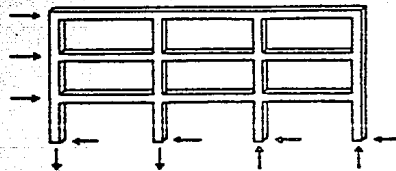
PLANTA DE UN EDIFICIO. ELEMENTOS ESTRUCTURALES
